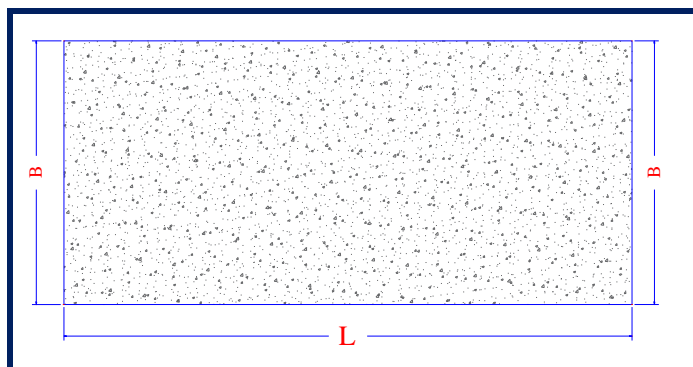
Modelamiento de zapata en planta, para área de cimentación.
